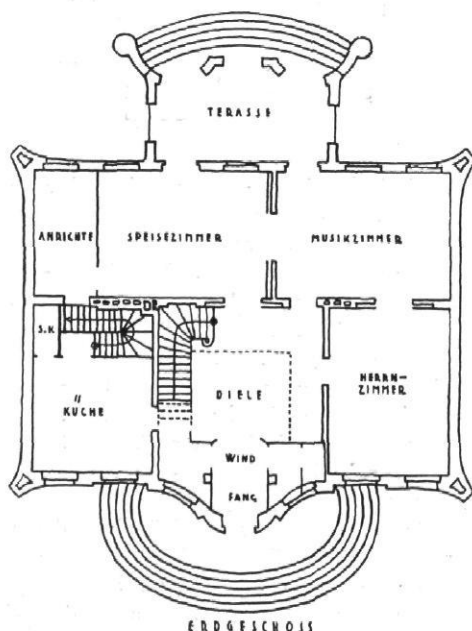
| Grundriß des Hauses Henkell, Grunewald | Maßstab 1:300
